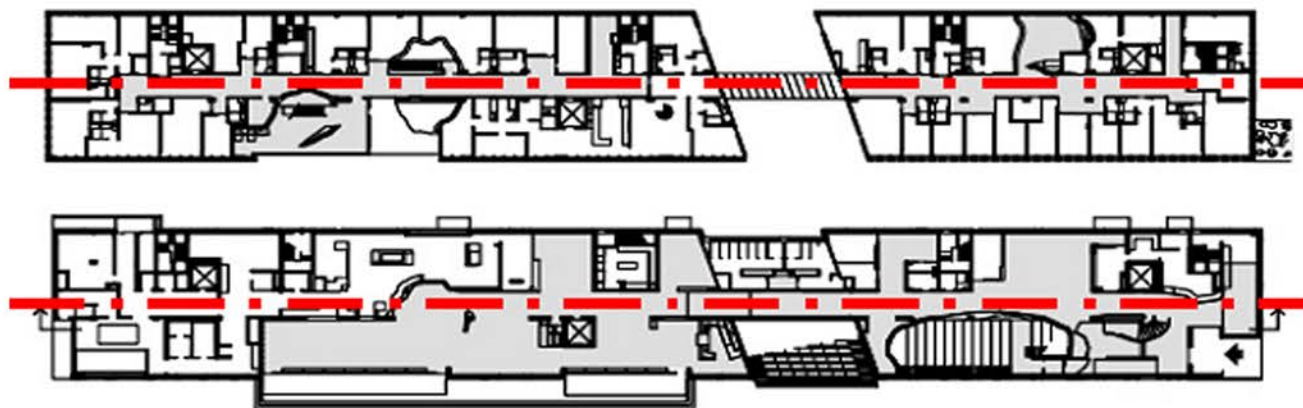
Esquema análisis de planta de la Residencia Simmons Hall. Fuente: <https://www.pinterest.com/pin/190417890471586489/>. Edición de imagen: Autores 2014
